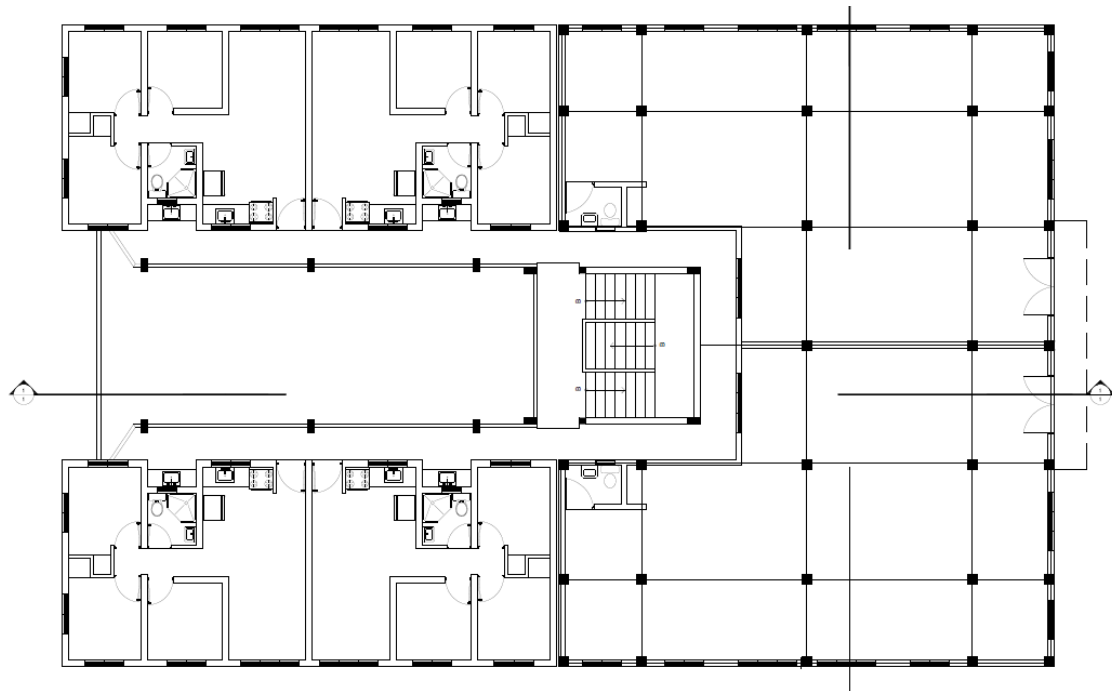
Planta tipo de vivienda y locales comerciales de la tipología H. (Abreu, 2013).
